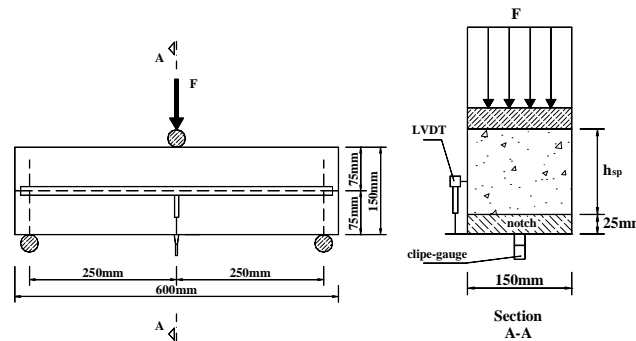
Ensaio de flexão sob três pontos de carga em viga entalhada (Vandewalle *et al.* 2000a).
